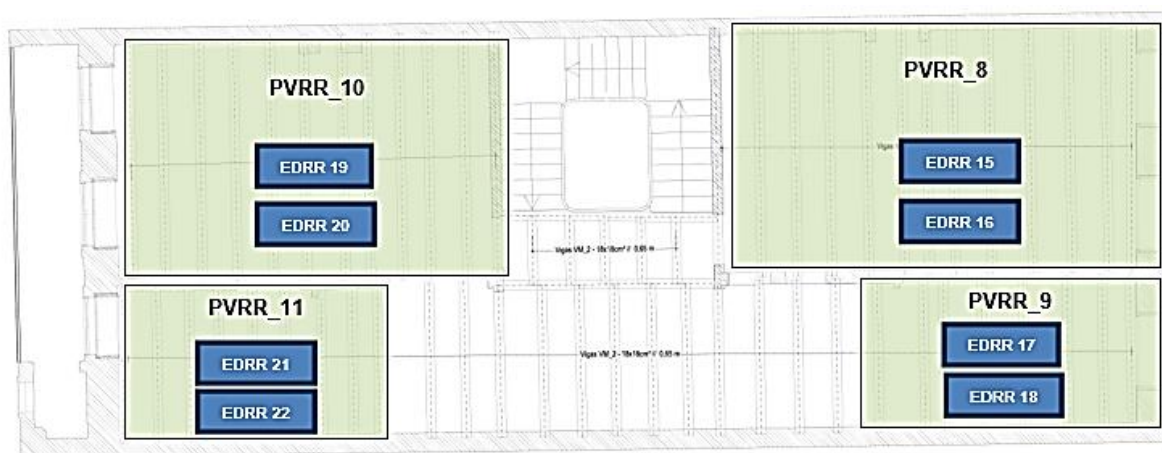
Planta do piso 2, com a identificação esquemática dos pavimentos e ensaios dinâmicos
